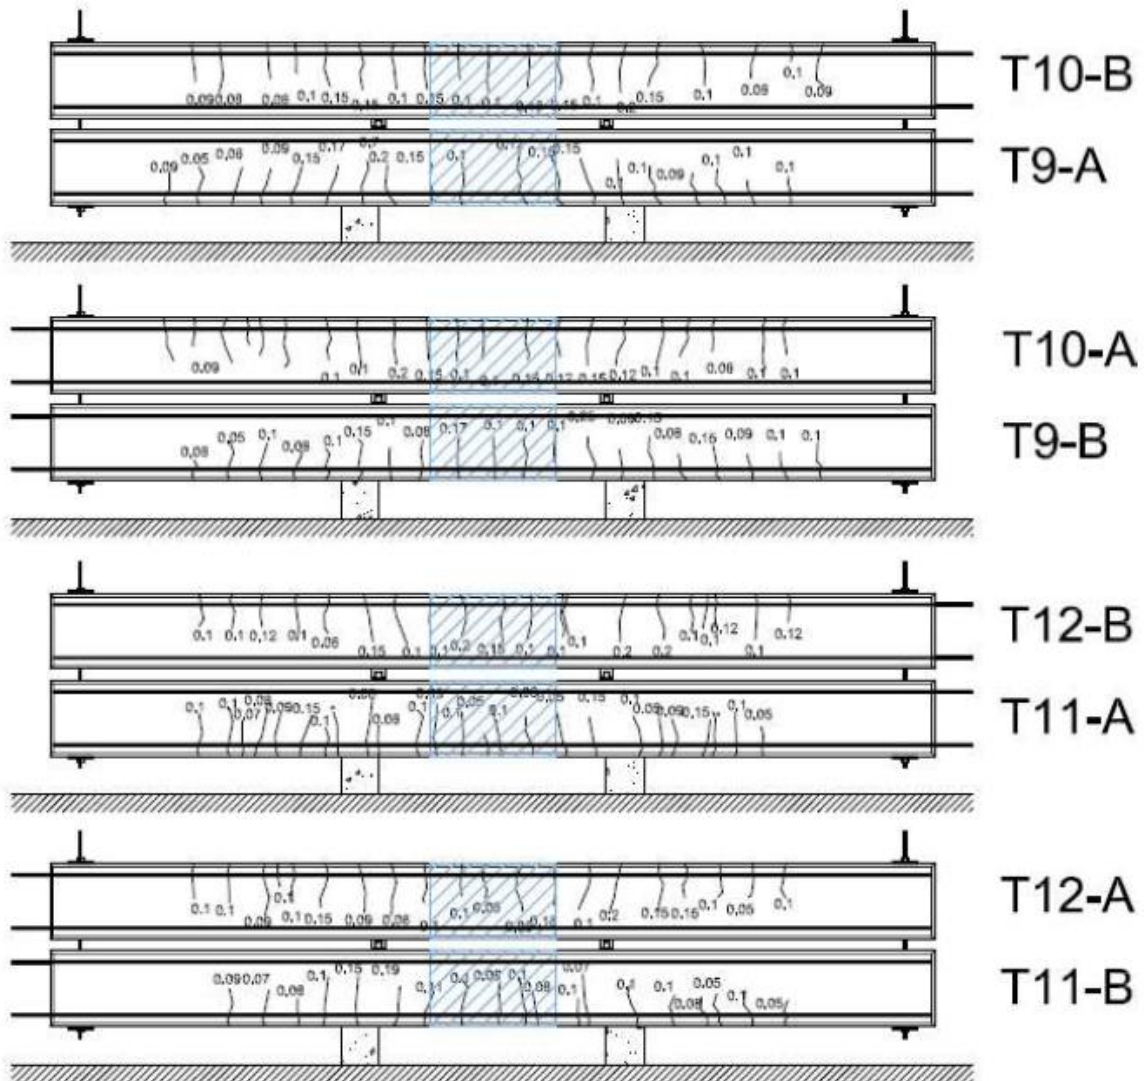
Esquema de grietas de traves T9 a T12 de CR con AR longitudinal a tensión de 13 mm de diámetro.
